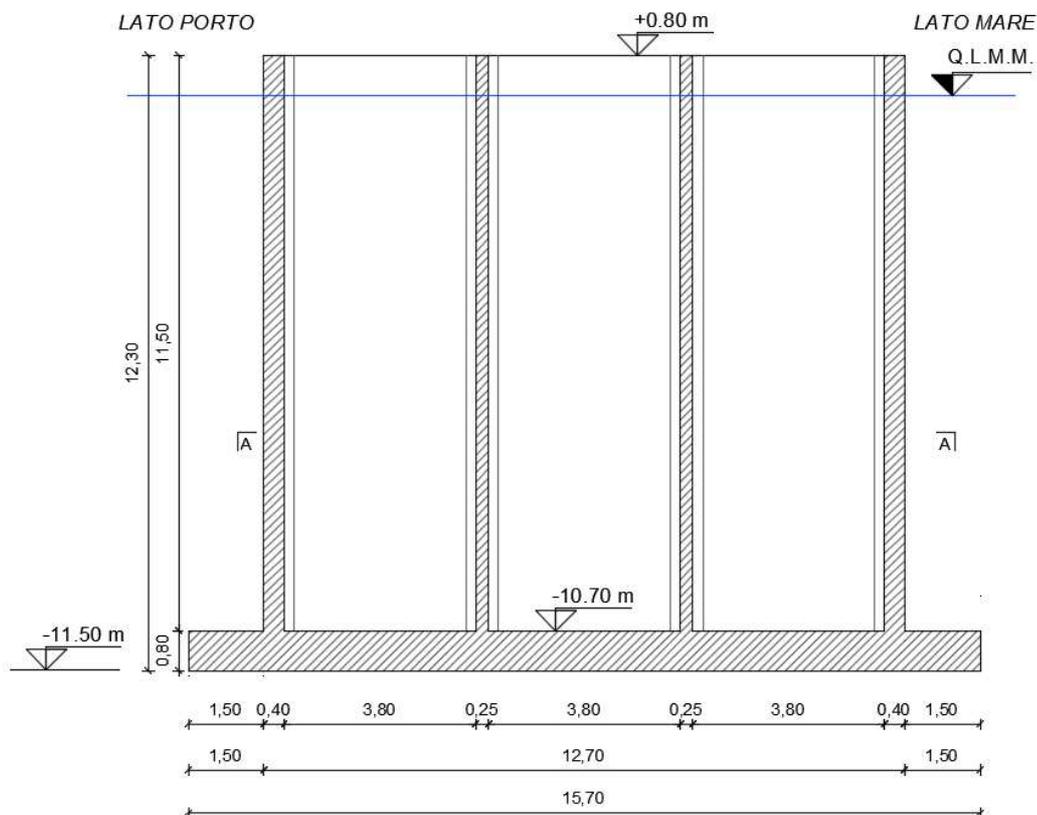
Cassoni tipo 2 (trapezio): Carpenteria - Sezione verticale trasversale B-B
